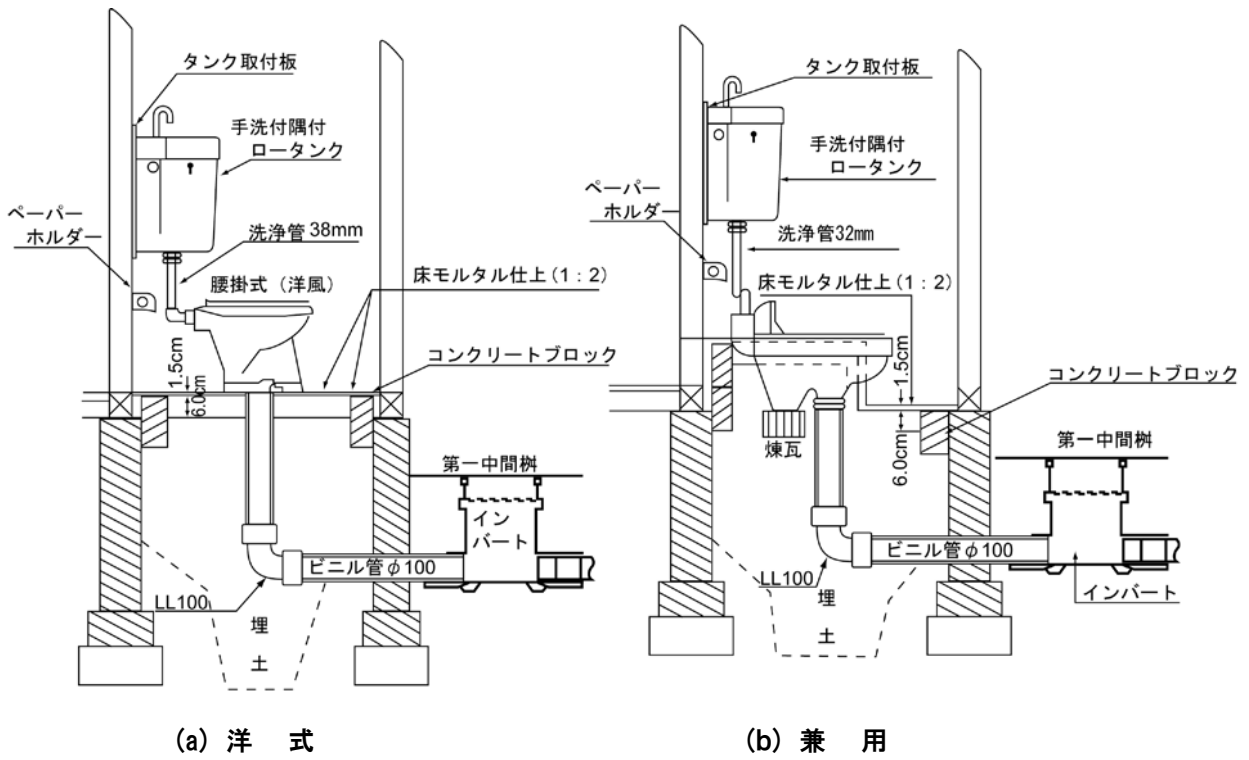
1 1 くみ取り便所の改造の施工図 (1)
